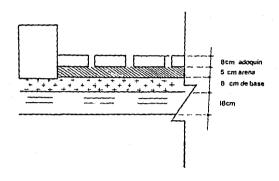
SECCION TRANSVERSAL TIPICA DEL PAVIMENTO PARA LA PLANTA LINGO BRONCE.
